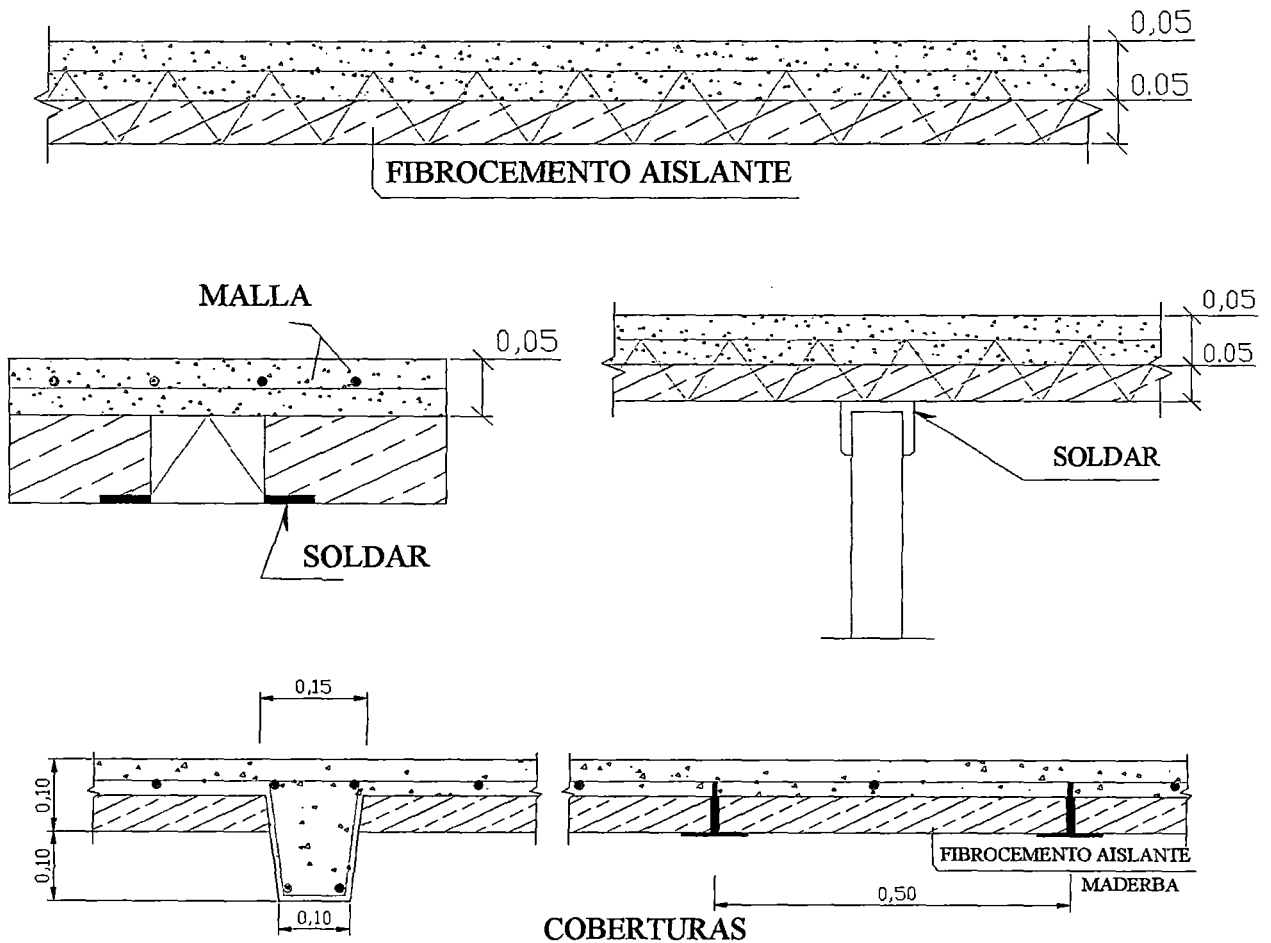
Detalles Típicos del Techo de un Campamento Minero
